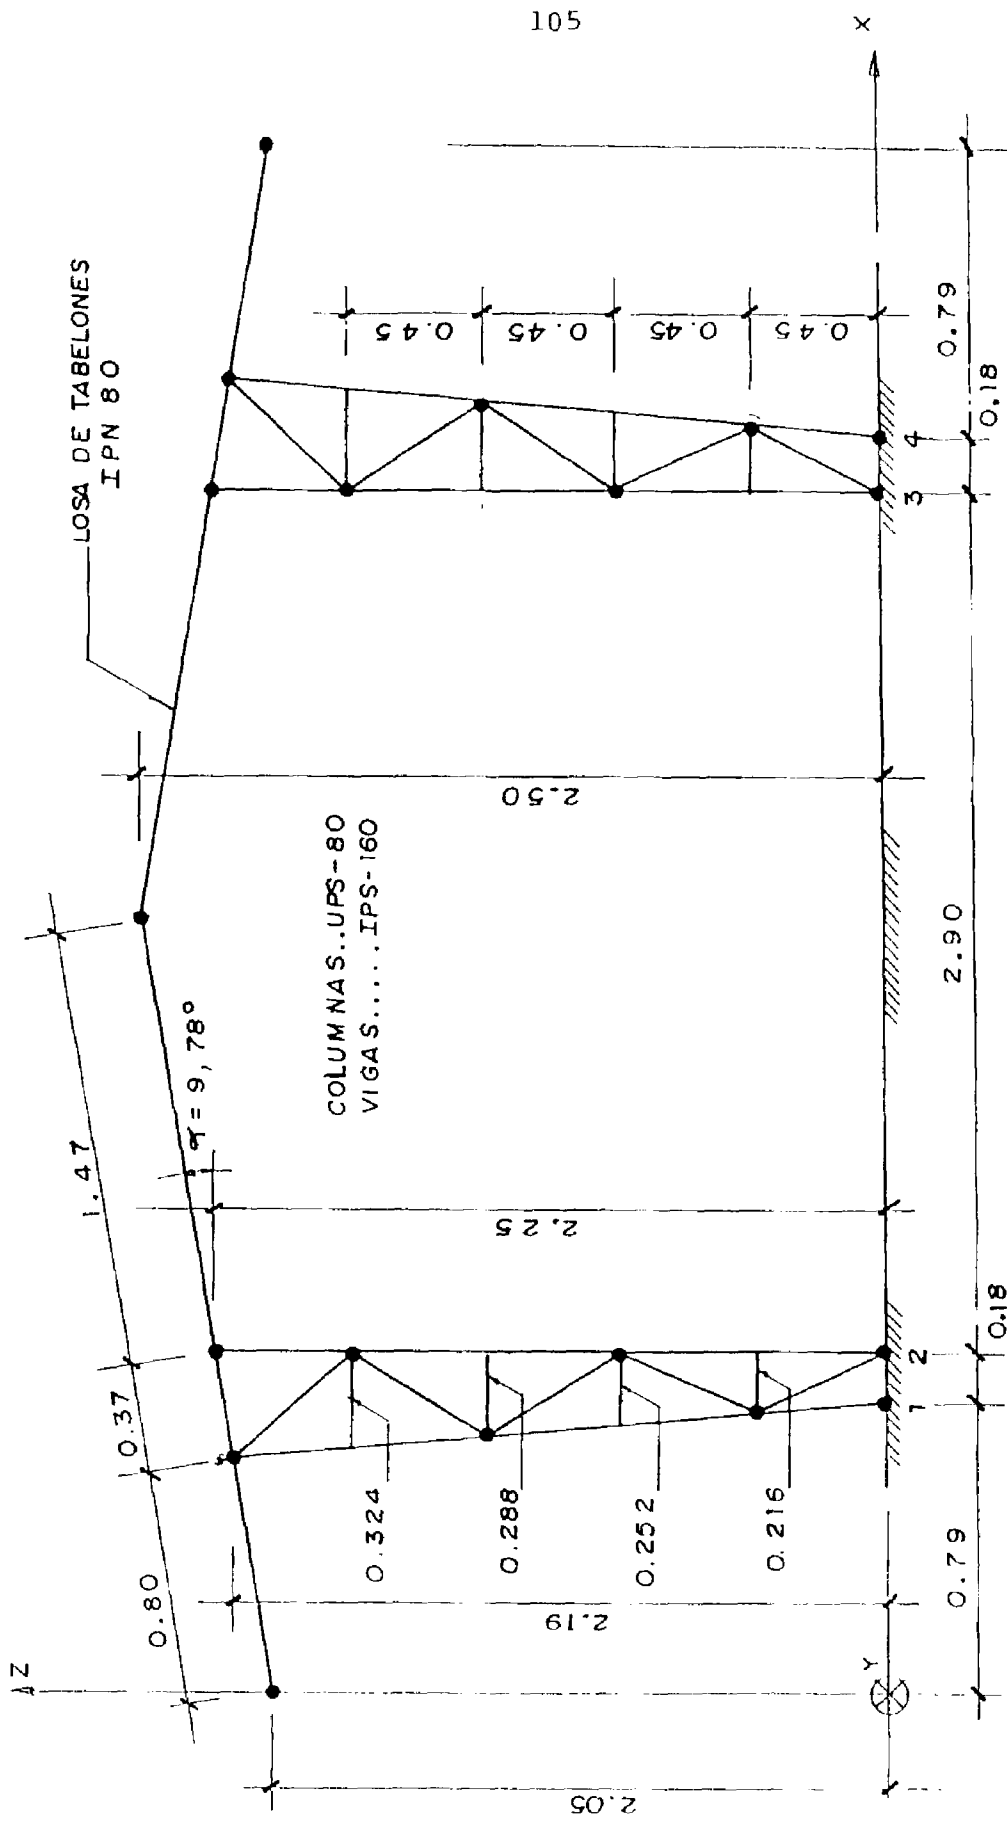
REFUERZO EN EL PLANO XZ
